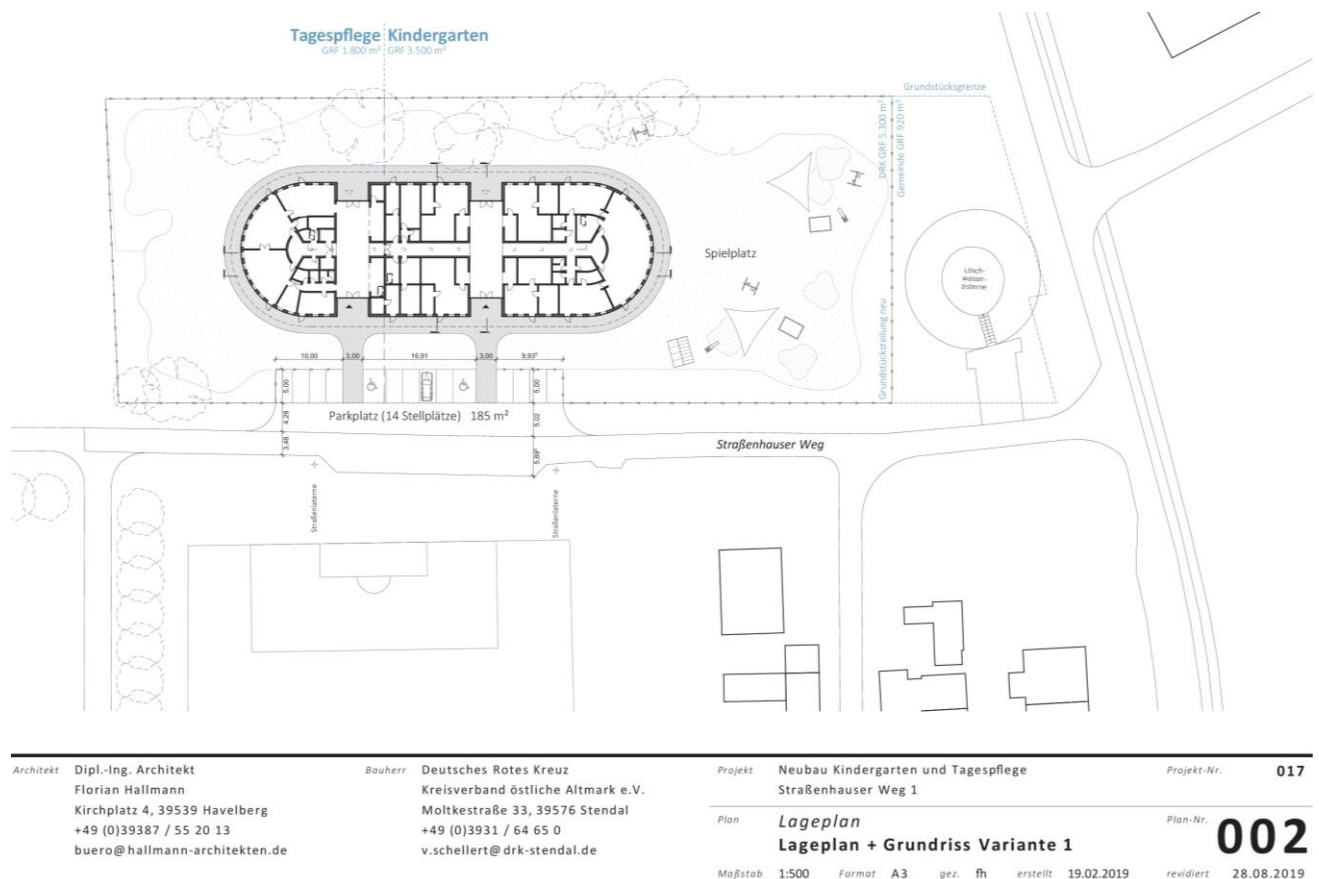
Lageplan + Grundriss zum Neubau der Kindertagesstätte und Tagespflege, Architekten Dipl.-Ing. Florian Hallmann
